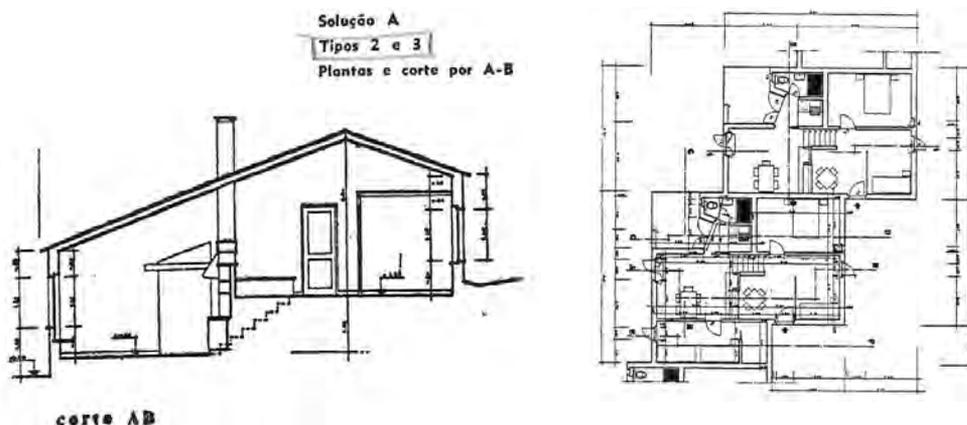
Bairro da Chamusca. Corte e planta da solução A (Tipos 2 e 3).
